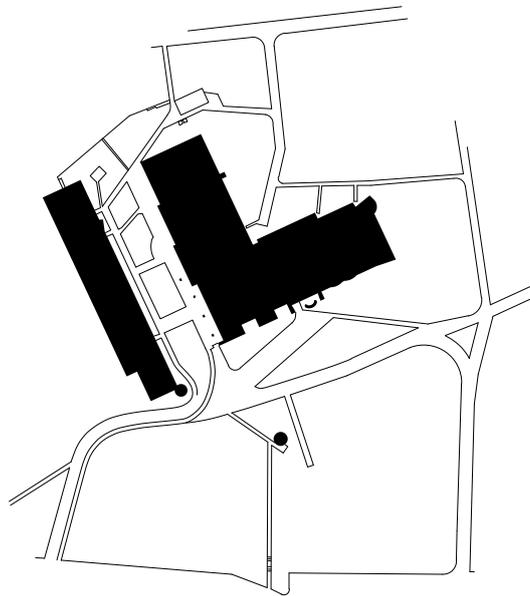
Lageplan St. Markus 1:2000 (BM)
